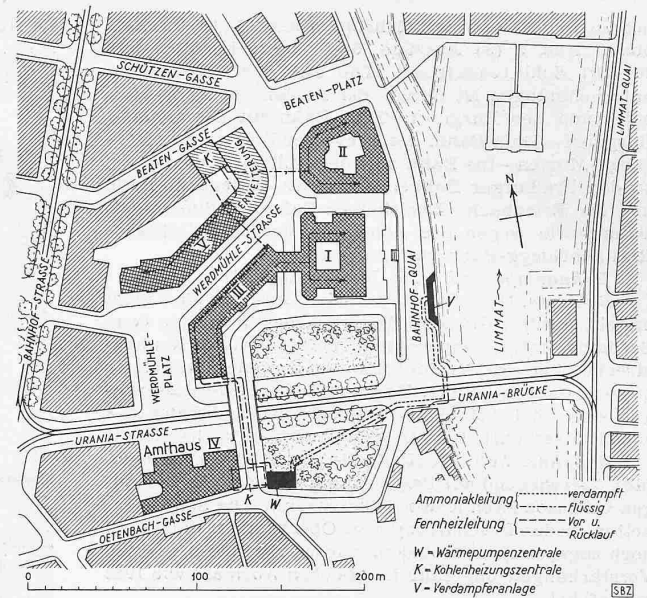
Die Wärmepumpenanlage der Städtischen Amthäuser in Zürich. Lageplan 1: 4000
